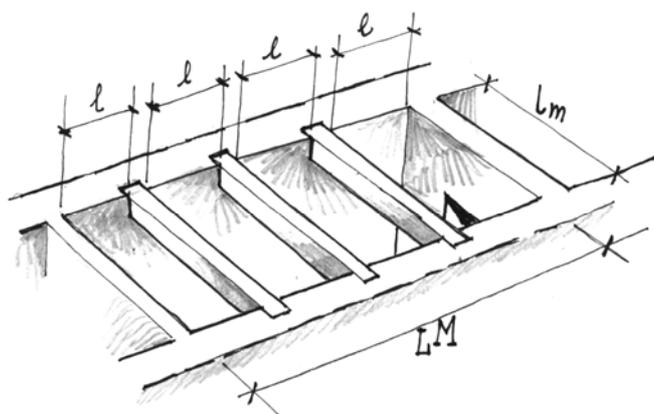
Disposizione delle travi nell'orditura del solaio.
